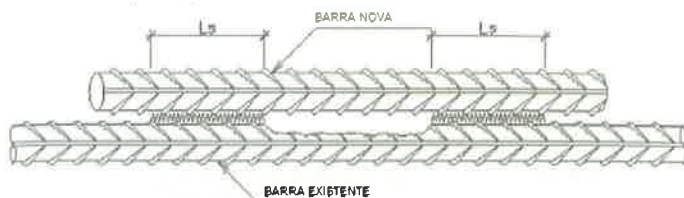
Reparo com emenda da armadura por traspasse.
